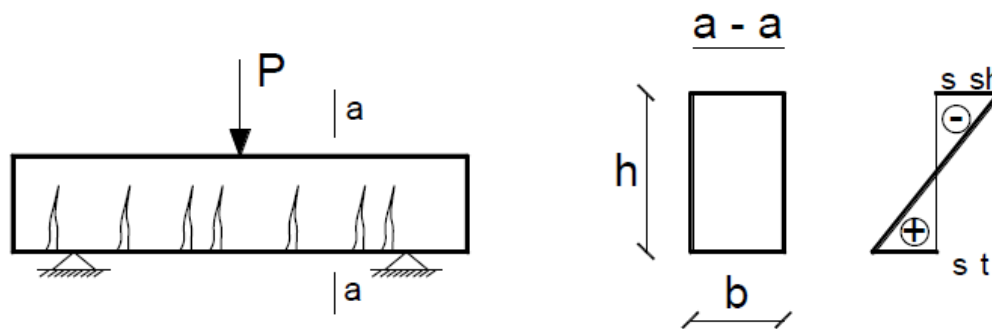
Mënyra e shkatërrimit të një trau prej betoni
